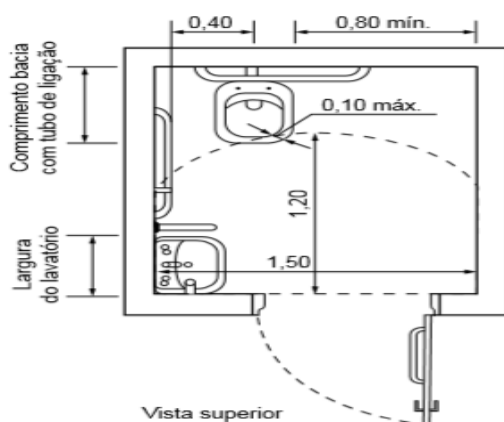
banheiro acessível ABNT 9050/20015 / banheiro acessível CERNDR
